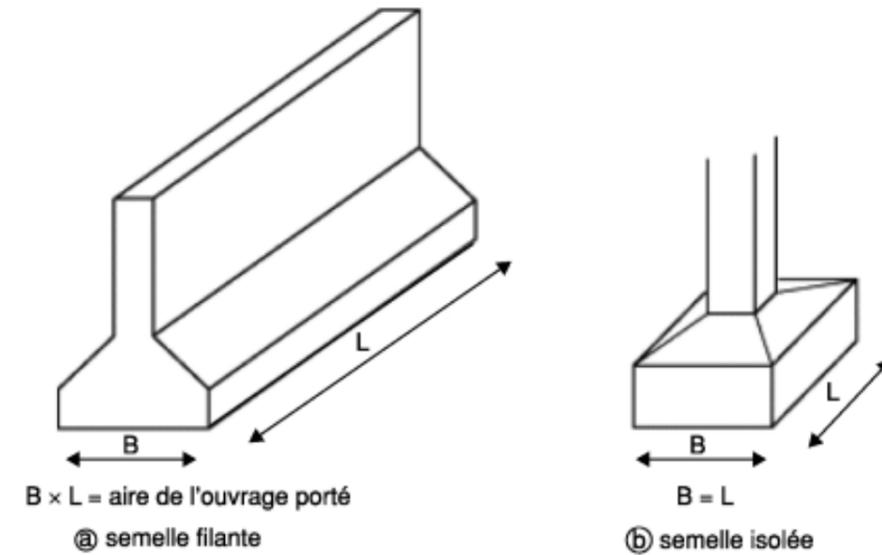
SEMELLE FILANTE ET ET SEMELLE ISOLEE SOURCE ; SOURCE : TECHNIQUES-INGENIEUR.FR.
